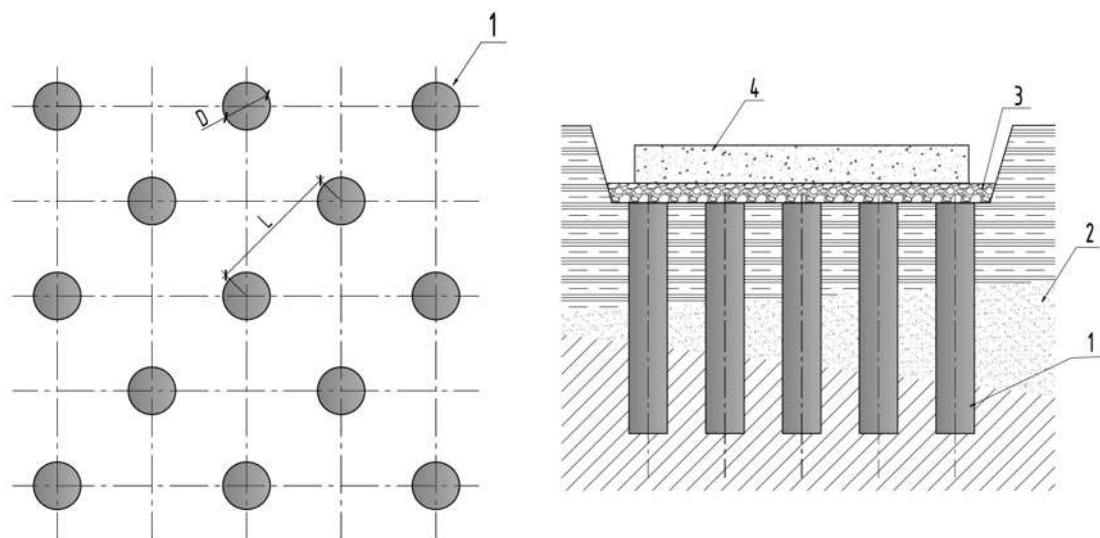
Конструктивное решение структурного геотехнического геомассива: план и вертикальный разрез: 1-вертикальные армирующие элементы; 2-грунтовое основание; 3- распределительный слой; 4 - фундаментная конструкция
